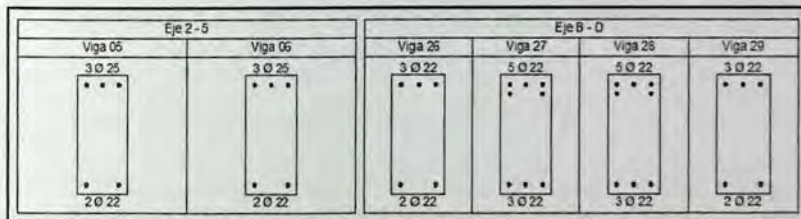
Distribución de refuerzo a flexión en vigas, ejes principales de estructura V (Nivel 1-3).
